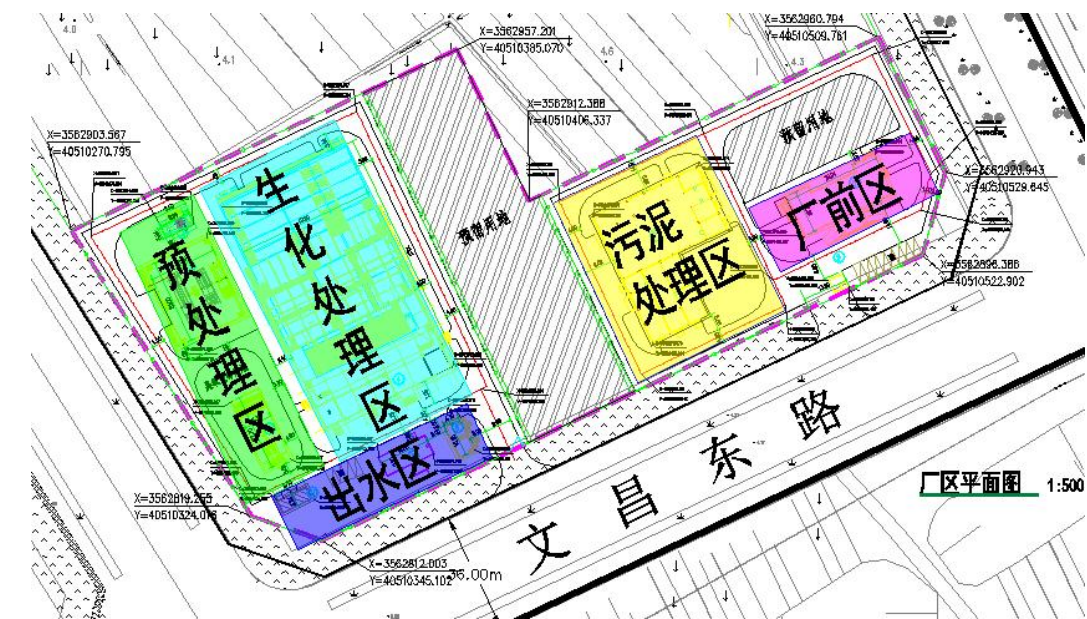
泰兴高新区工业污水厂厂区现状平面图
